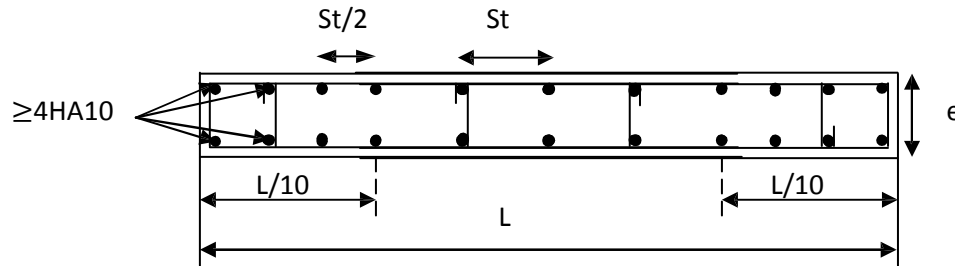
Schéma d'une coupe horizontale d'un voile.
